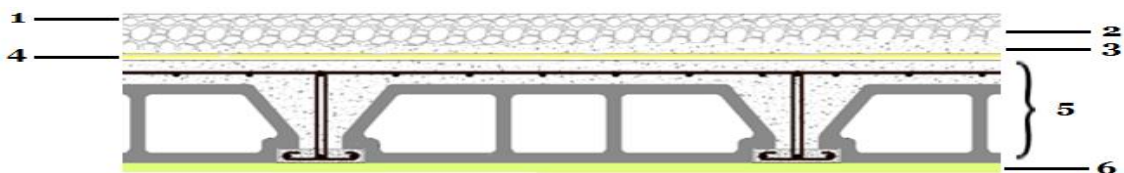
Coupe transversale d'un plancher terrasse inaccessible en corps creux.
